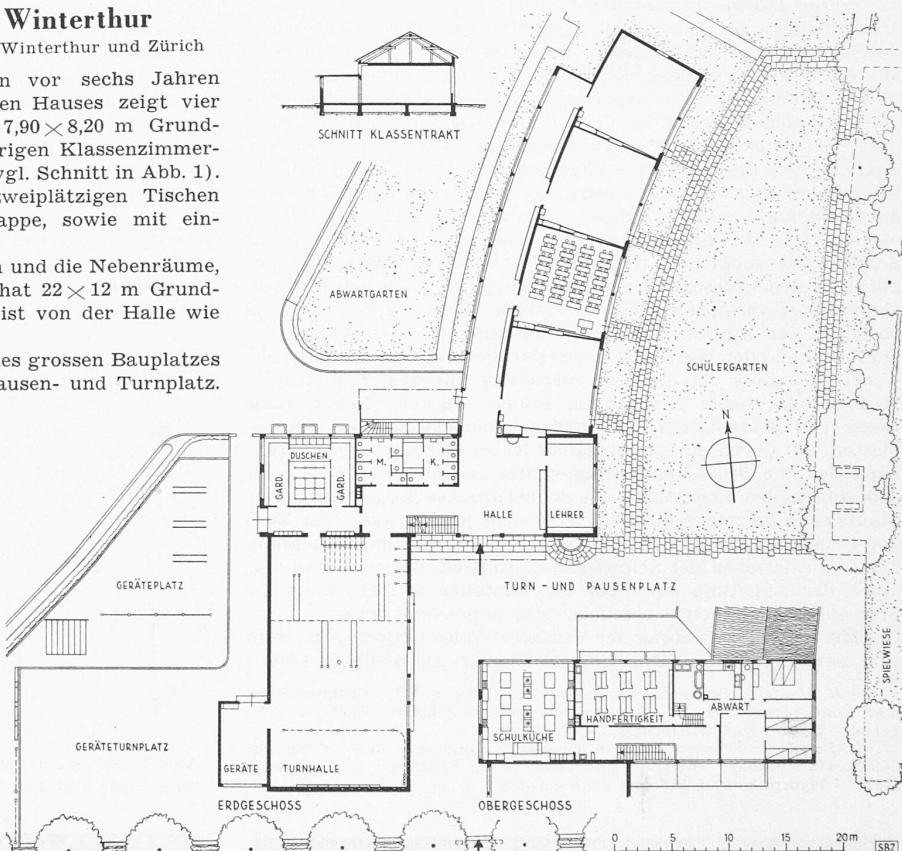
Grundriss Erdgeschoß und Obergeschoß des Mitteltraktes, Maßstab 1:600
